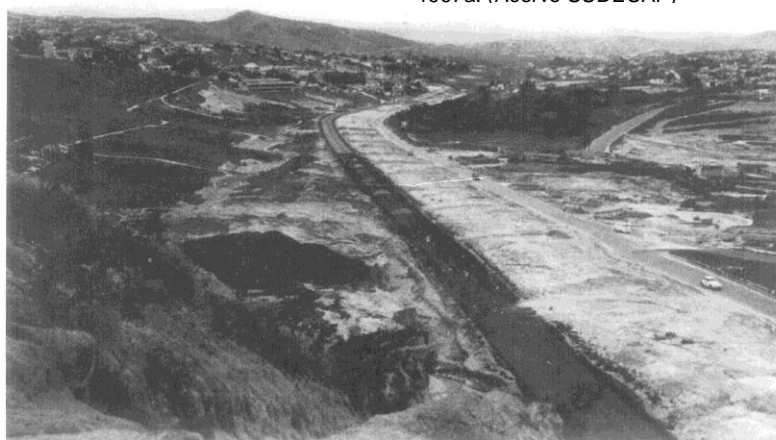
Obras de implantação da Avenida Cristiano Machado, 1973 - Fonte: Fundação João Pinheiro, 1997a (Acervo SUDECAP).
